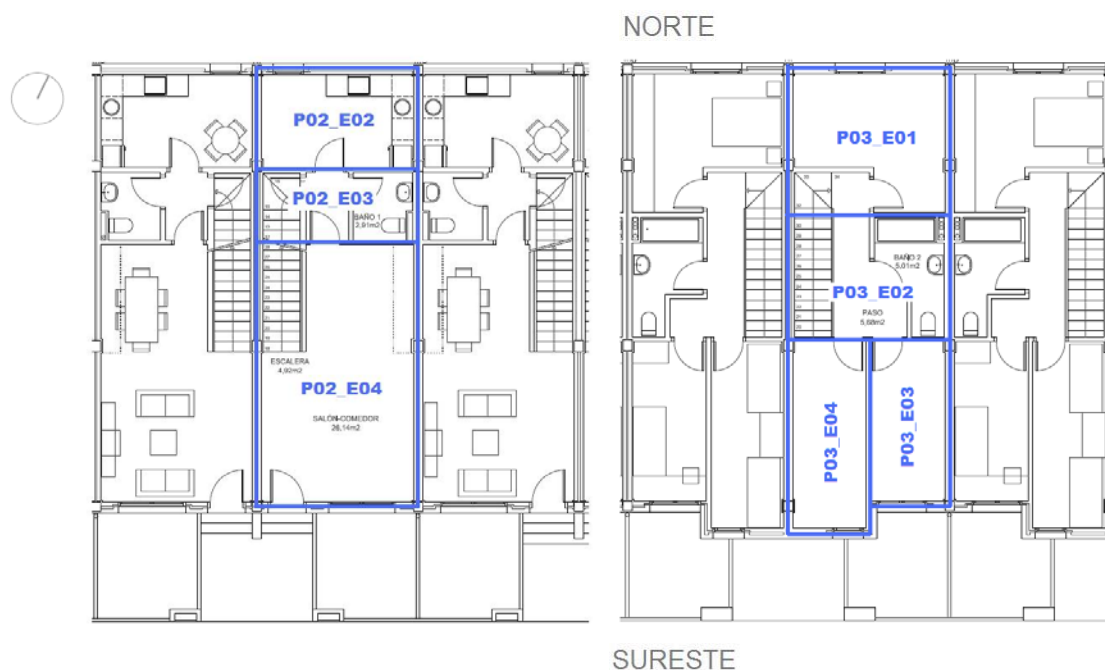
Planta baja (izquierda) y primera planta (derecha). Vivienda unifamiliar de Murchante.
